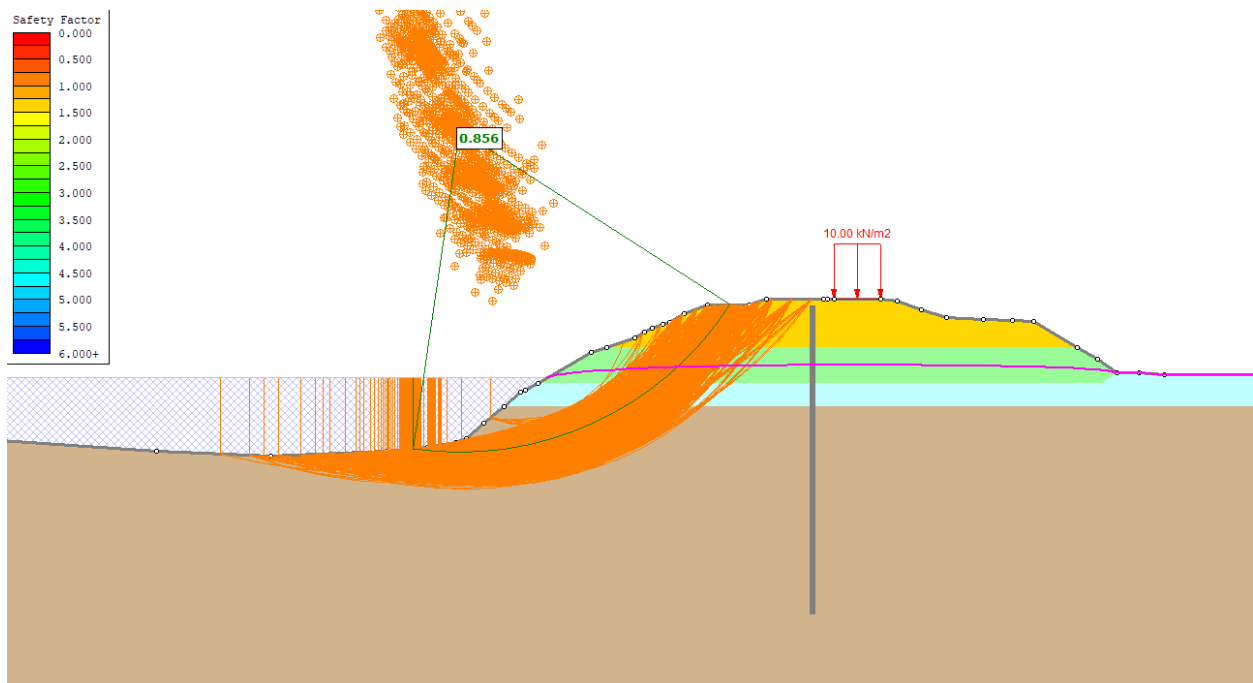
Sezione n.5 – Stato di progetto – Analisi statica di svasso rapido dalla quota di piena SIMPO '82 – Parametri non drenati – Superfici di rottura con ODF < 1
